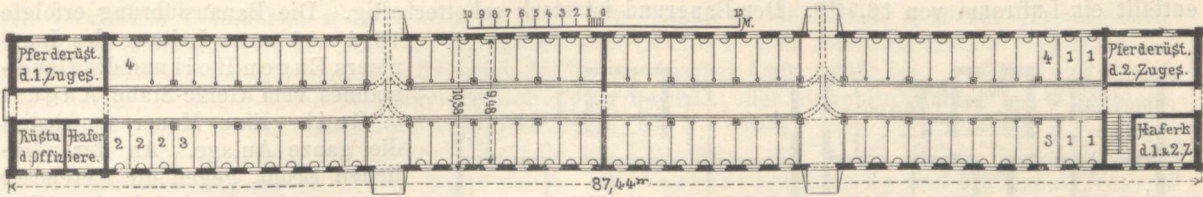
Stall für 1/2 Escadron, mit Pferderüstungs- und Futterkammern.
